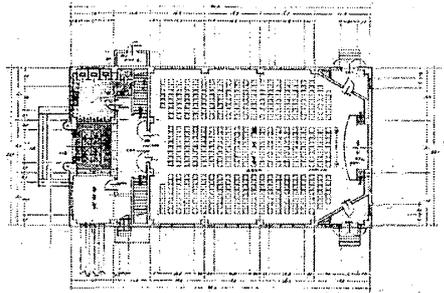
「宝塚公会堂新築設計図 1 一階平面図」より（部分 竹中工務店蔵）
